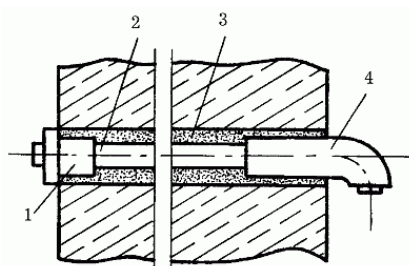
Конструкция прохода через стену: 1 – втулка; 2 – трубка; 3 – раствор цементно-алебастровый; 4 – воронка
